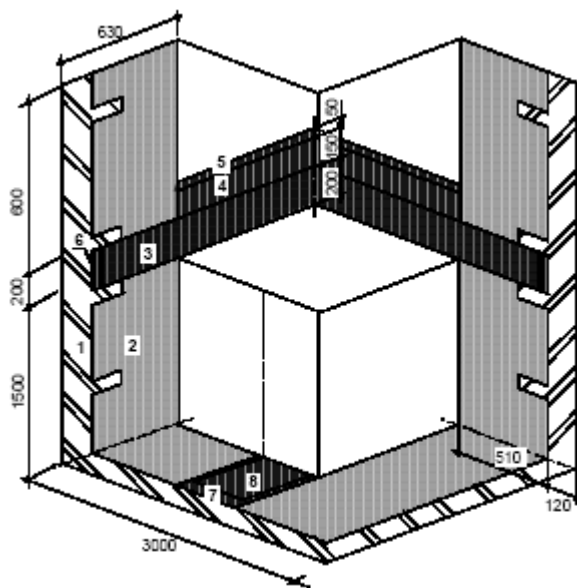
Расчетная схема узла сопряжения наружного выступающего угла с конструкцией чердачного перекрытия «теплого» чердака жилого здания:
